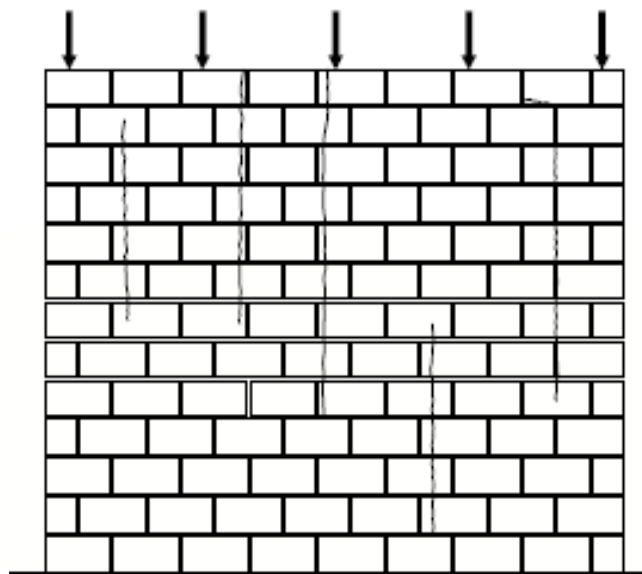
Configuração das fissuras originadas pelo carregamento excessivo de compressão.
